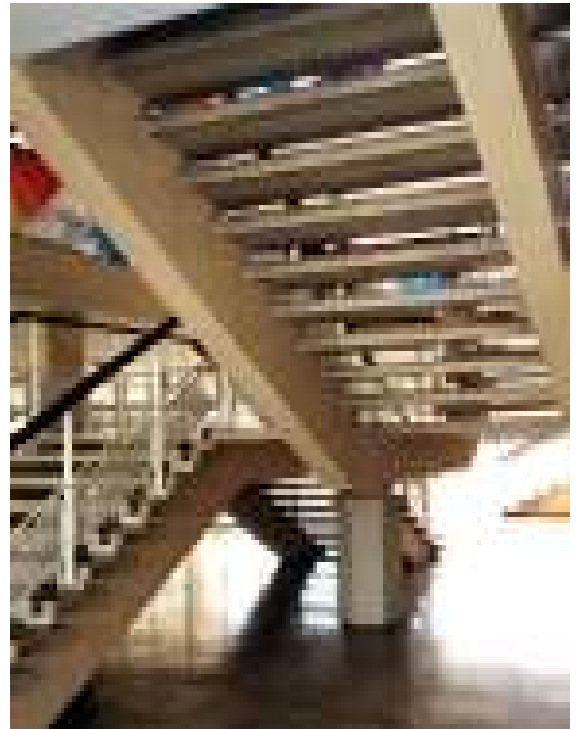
e 90- Novos revestimentos substituíram os originais, observar escada e piso do pavimento térreo.
